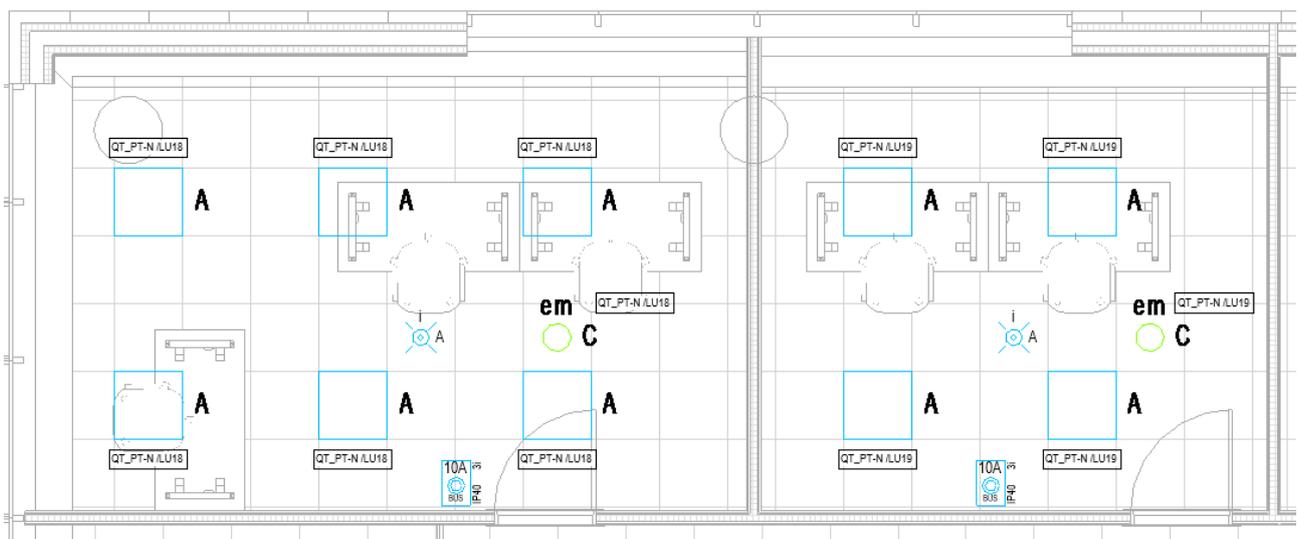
Vista in pianta dell'impianto di illuminazione con circuiti a dettaglio Basso
